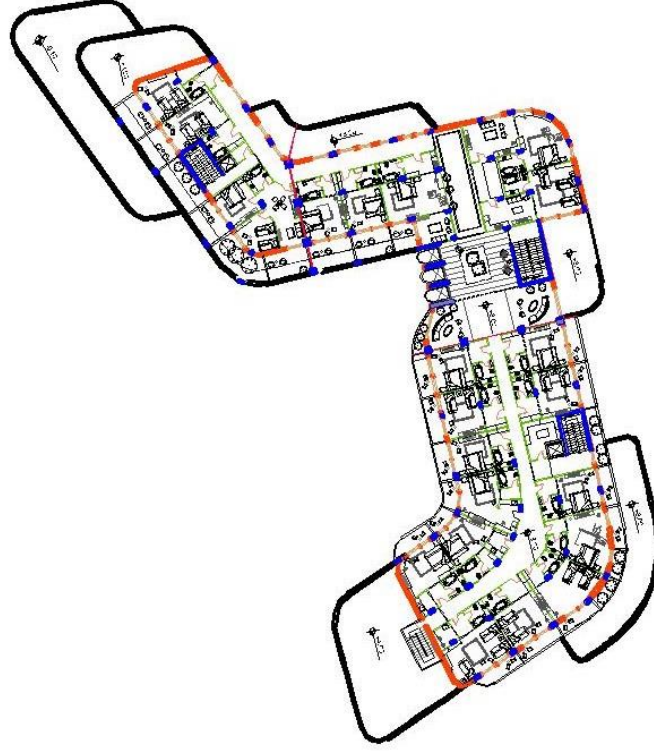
المسقط الأفقي للطابق الأول.
